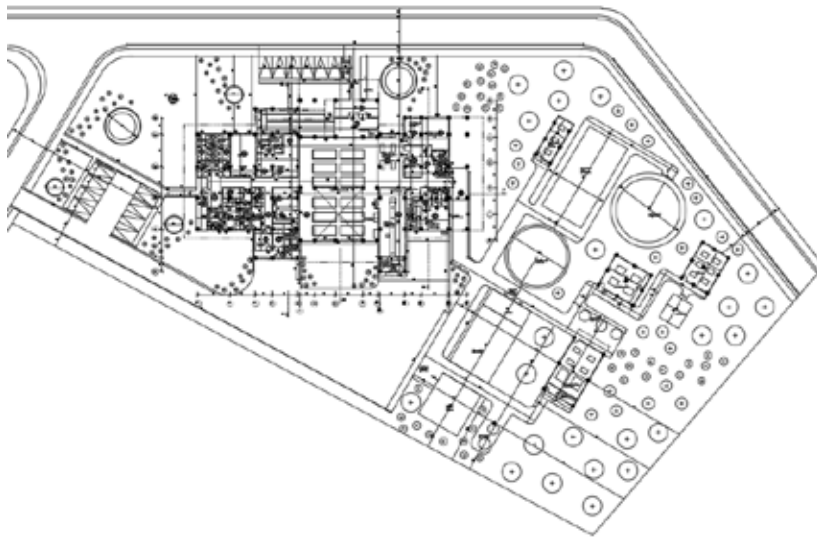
Planta Baja Nivel +0.15 m (2018)
